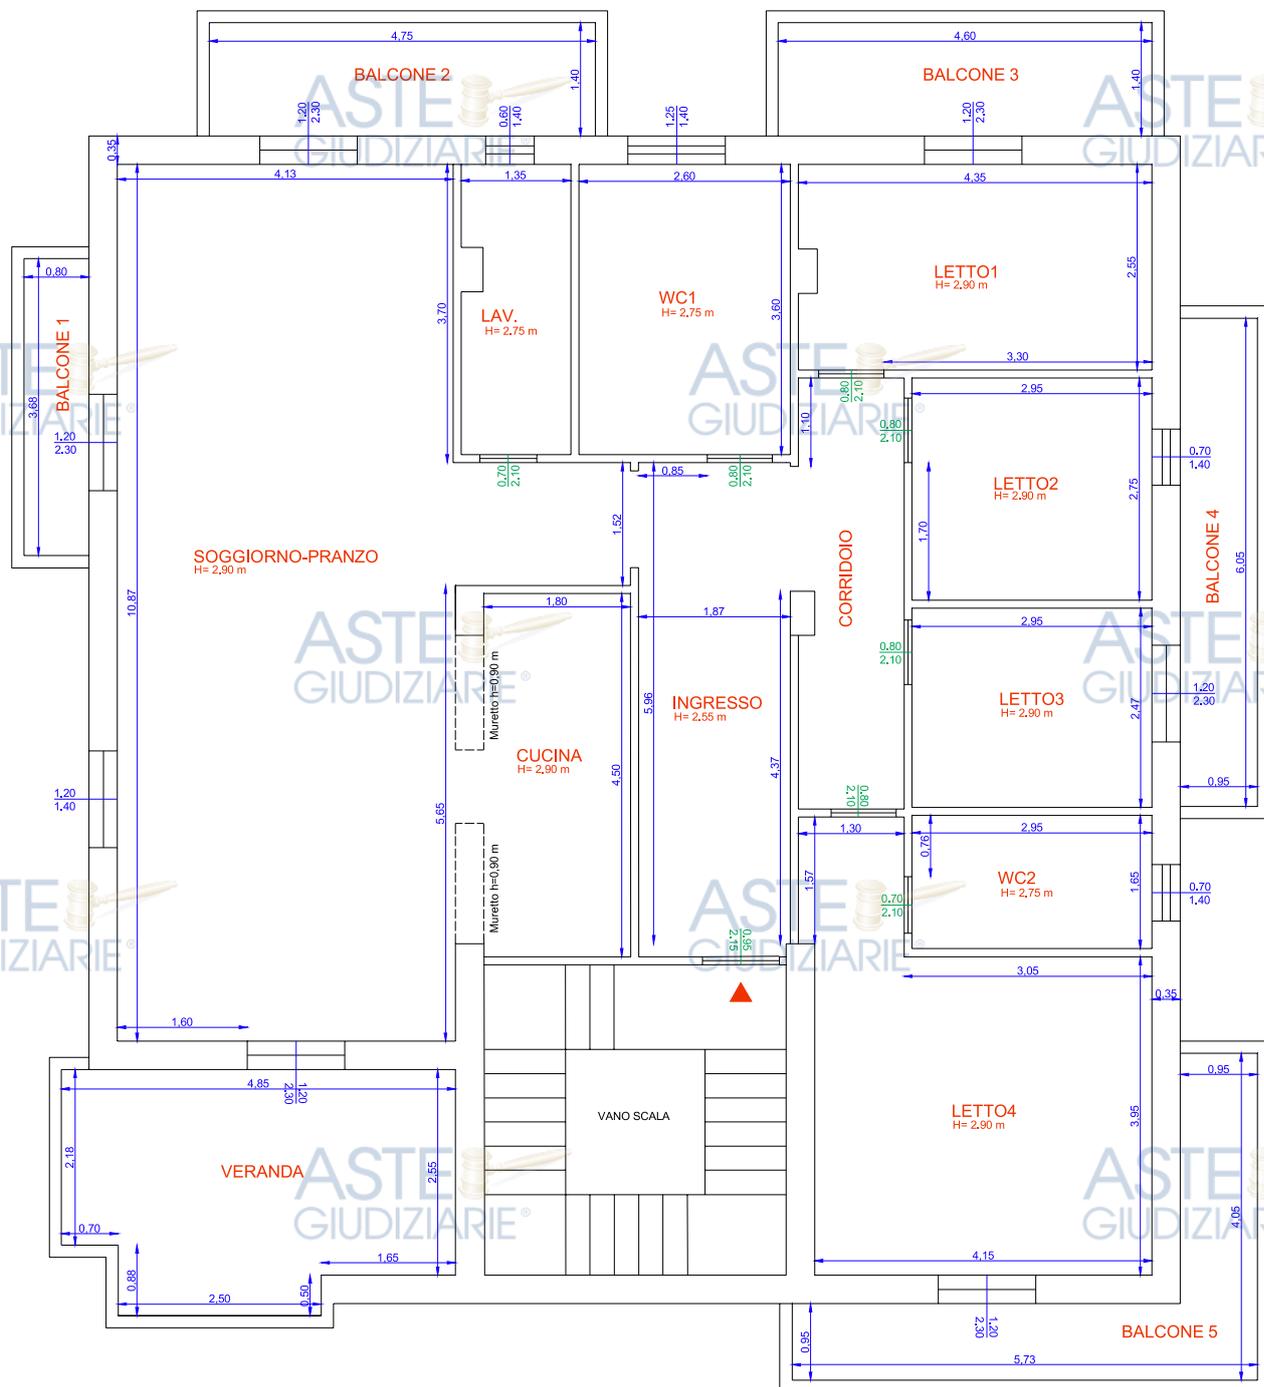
Planimetria da rilievo BENE C - Appartamento
